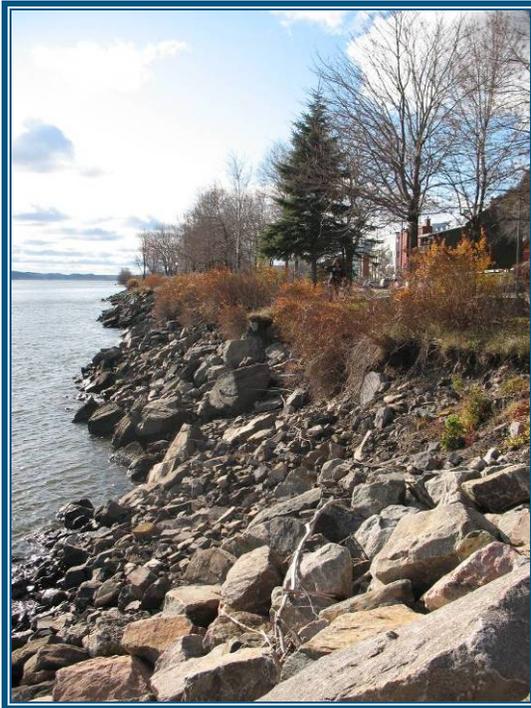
Matériaux (enrochement et béton) sur les pentes – secteur EB07-EB15 (novembre 2011).
